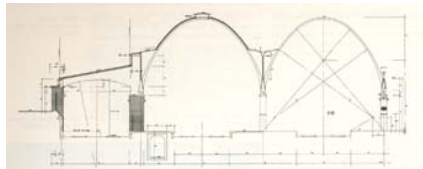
Estação Ferroviária Santa Justa, Sevilha, Espanha. Arqs. Cruz e Ortiz, 1988-1991. Corte transversal das coberturas das plataformas. Fonte: Revista Projeto 156, p.111
